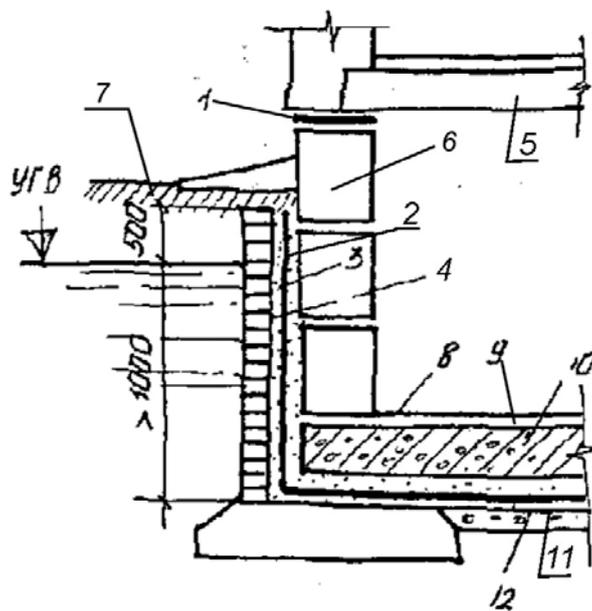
Гидроизоляция фундамента: 1 — рулонная гидроизоляция; 2 — окрасочная гидроизоляция; 3 — оклеечная гидроизоляция; 4 — защитная стенка из кирпича; 5 — плита перекрытия; 6 — фундаментный блок; 7 — глина; 8 — пол подвала; 9 — стяжка; 10 — железобетонная плита; 11 — пригрузочный слой из бетона; 12 — песчаная подготовка
